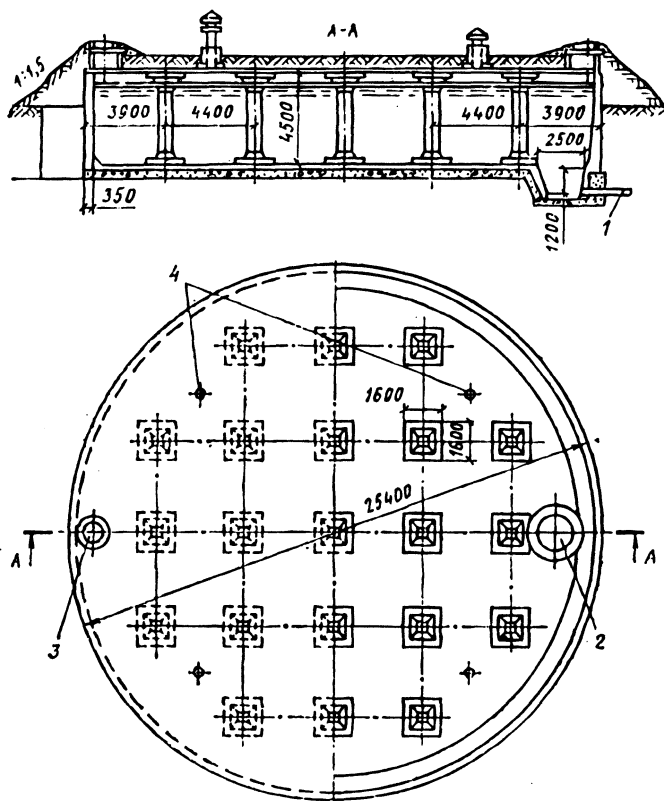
Конструкция резервуара цилиндрической формы:
